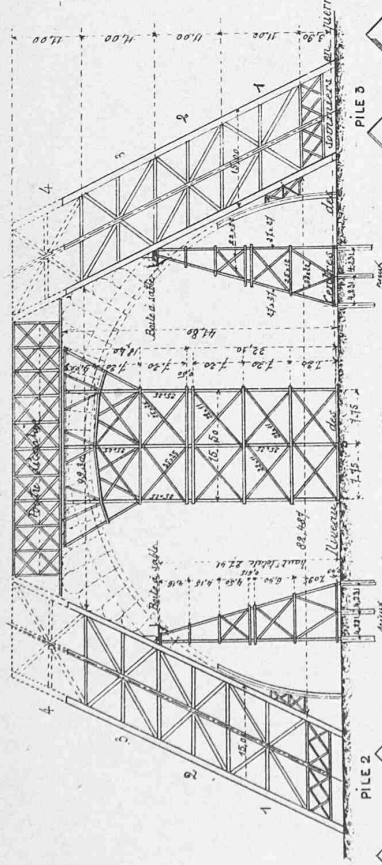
Elévation suivant A. B. (Plan Fig. 2)
